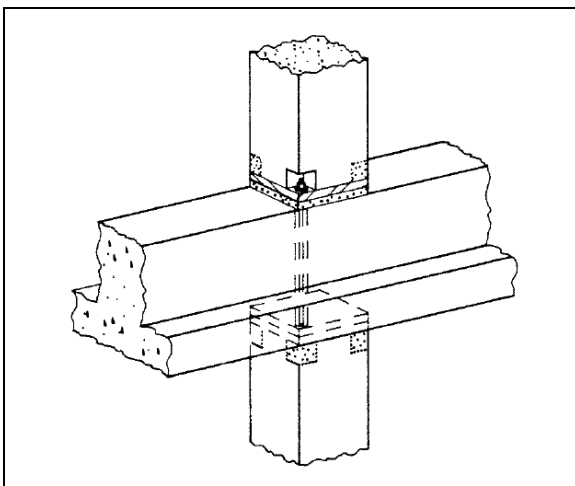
Interrupção de pilar com ligação por varão roscado (Sidney, 2000)
